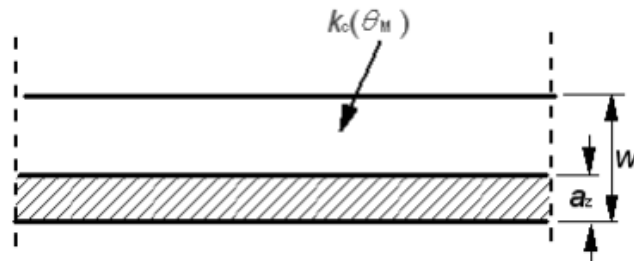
réduction de la section droite d'une dalle exposée au feu sur un seul coté
